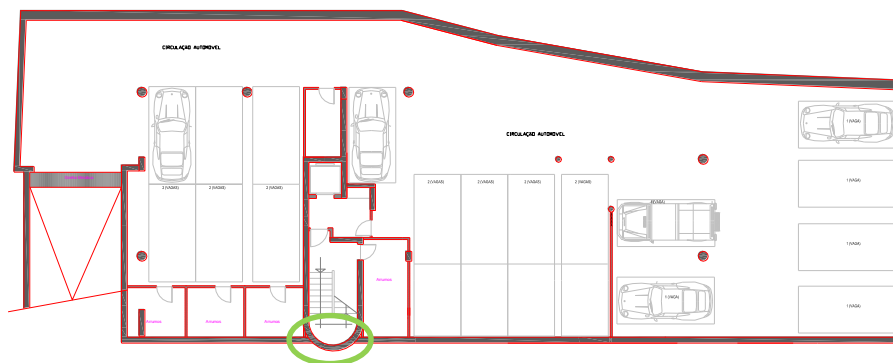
Planta da cave, marcado a verde o elemento adaptado, (sem escala)
